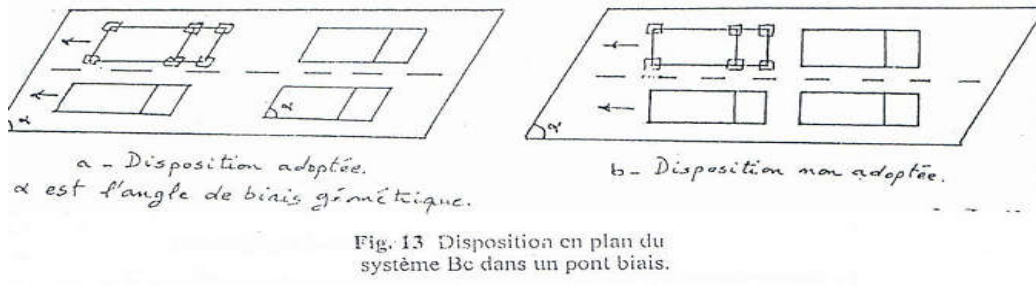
Disposition en plan du système Bc dans un pont biais.
